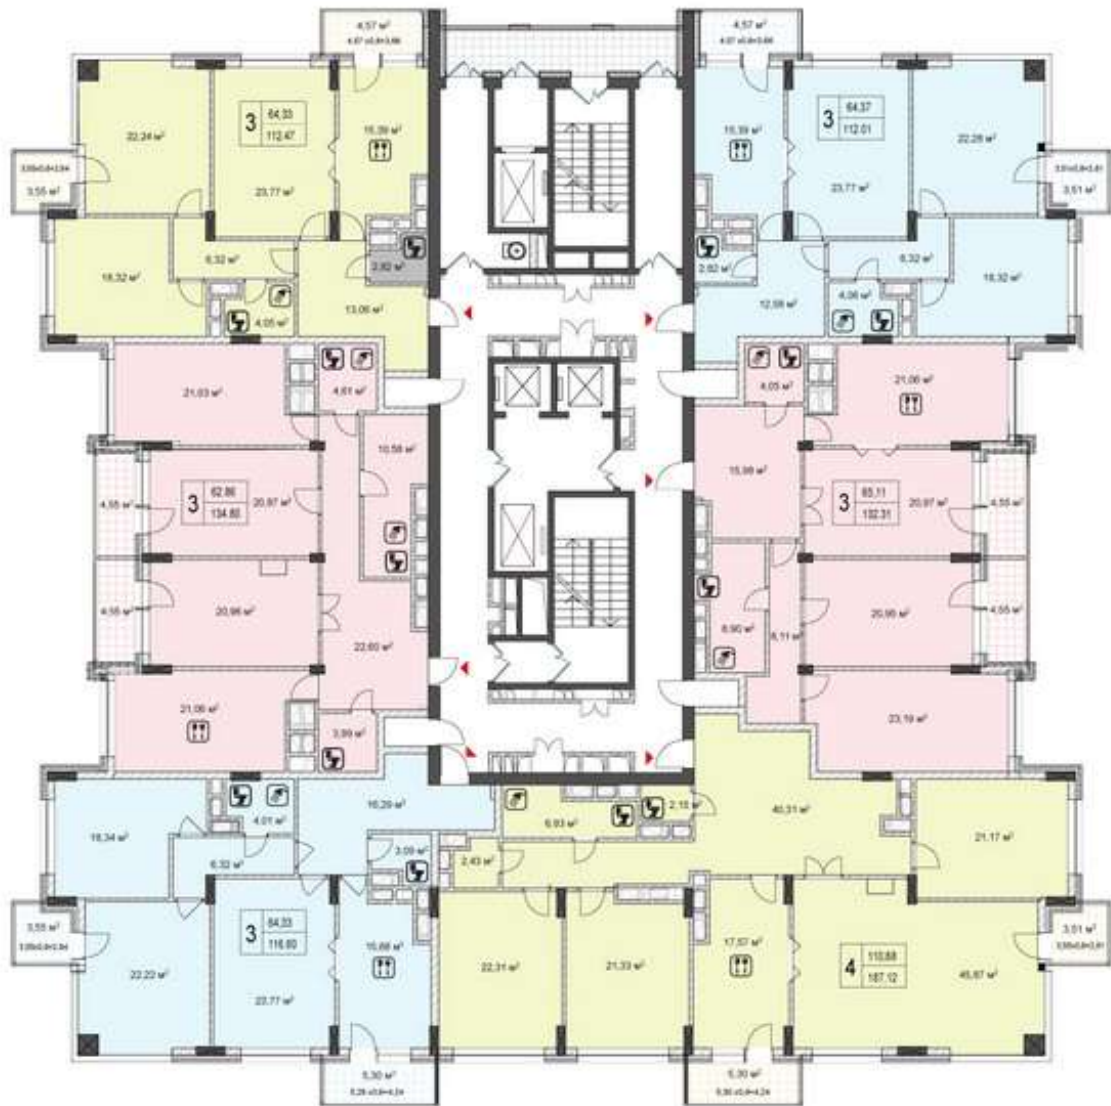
План типового поверху ЖК «Новопечерські Липки», Київ, 2017 р. [10]
